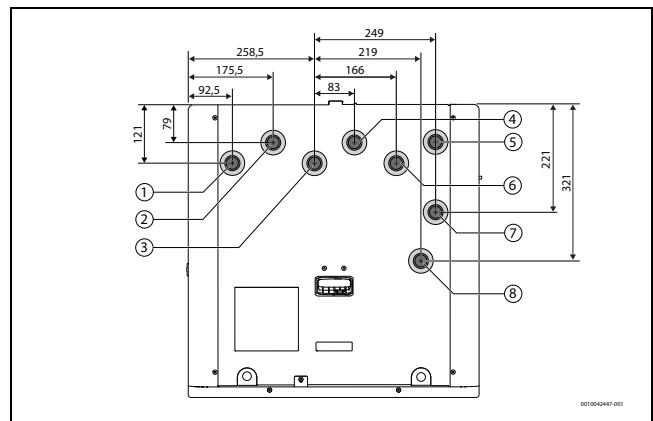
Ansicht von oben: Positionen der Anschlüsse (Maße in mm)
